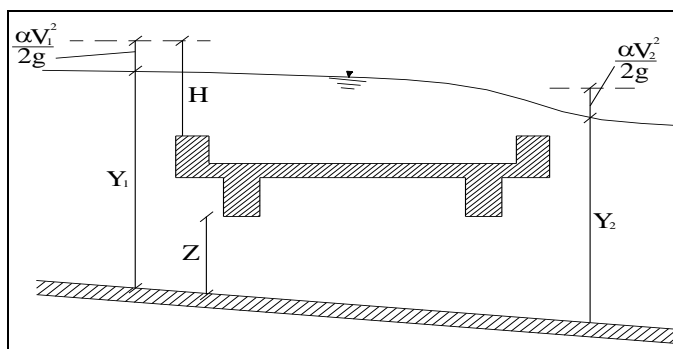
Sezione schematica di un ponte – Schema di calcolo
